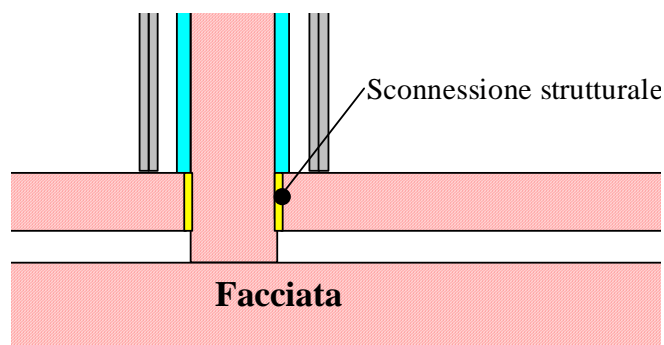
Raccordo tra facciata a doppio strato in laterizio e parete di separazione tra alloggi.
